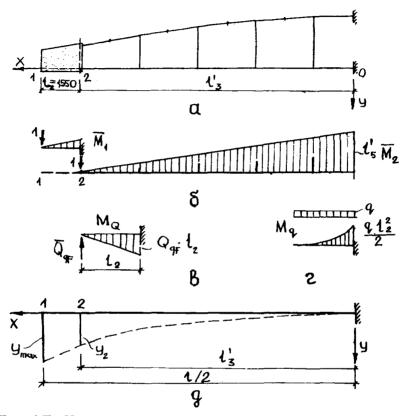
К определению прогибов дизфрагмы панели КСО а-геометрическая схема; в г-эпюры моментов соответ-ственно от единичных сил, нагрузки он поперечной нагрузки. Приложенной в пределах опроисто сплошного участка диафрагмы; д-схема прогибов; 1,2-помера узлов
